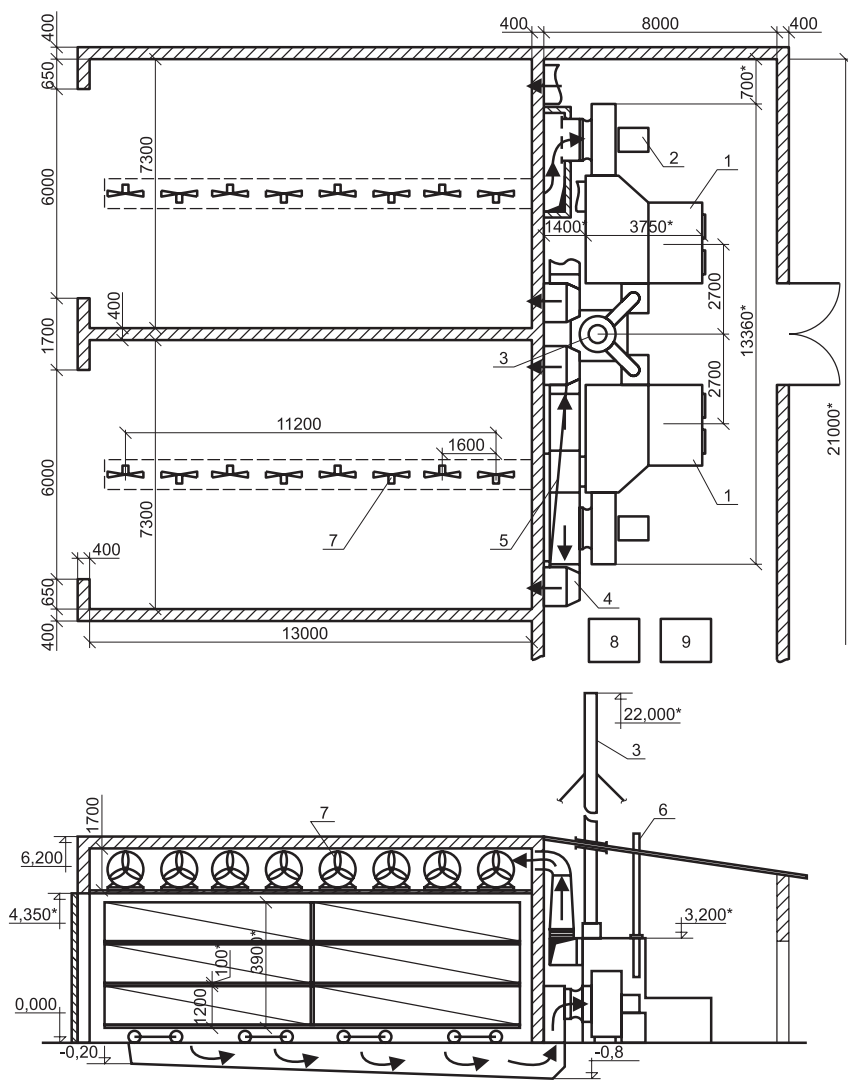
СК 2×100 м³ на древесных отходах: 1 – теплоагрегат УВН-500; 2 – вентилятор Ц4-75 №10; 3 – труба дымовая ТП 907-2-204-86КМ; 4 – воздуховод напорный; 5 – воздуховод всасывающий; 6 – воздуховод сбора влаги; 7 – вентилятор СК-800 №8 реверсивный; 8 – система контроля ИВТ-2; 9 – система управления АСК-6
